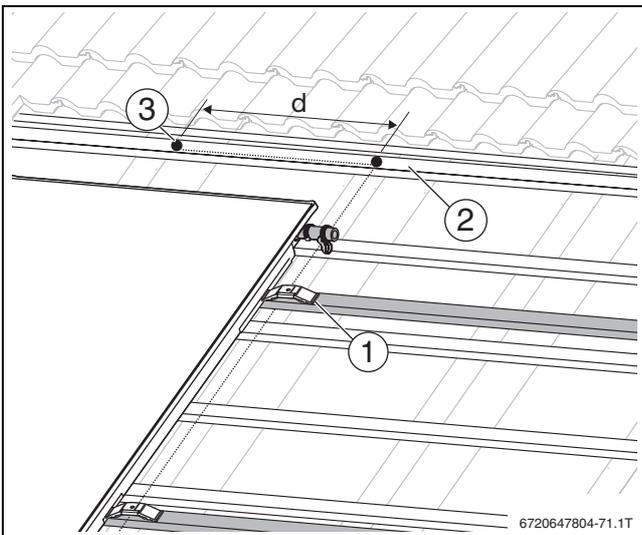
Posición de montaje del conector superior en colectores horizontales
